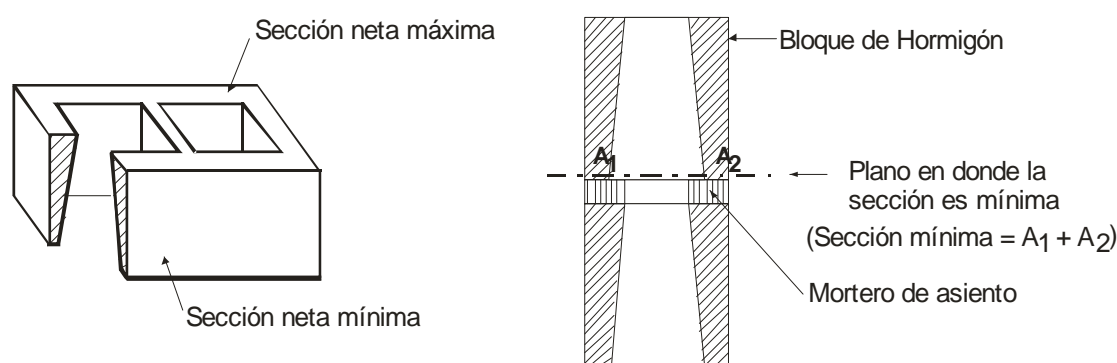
c. Sección neta mínima en bloques huecos de hormigón.
